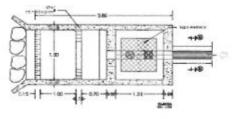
Vista en Planta y Corte del sistema de control y limpia
